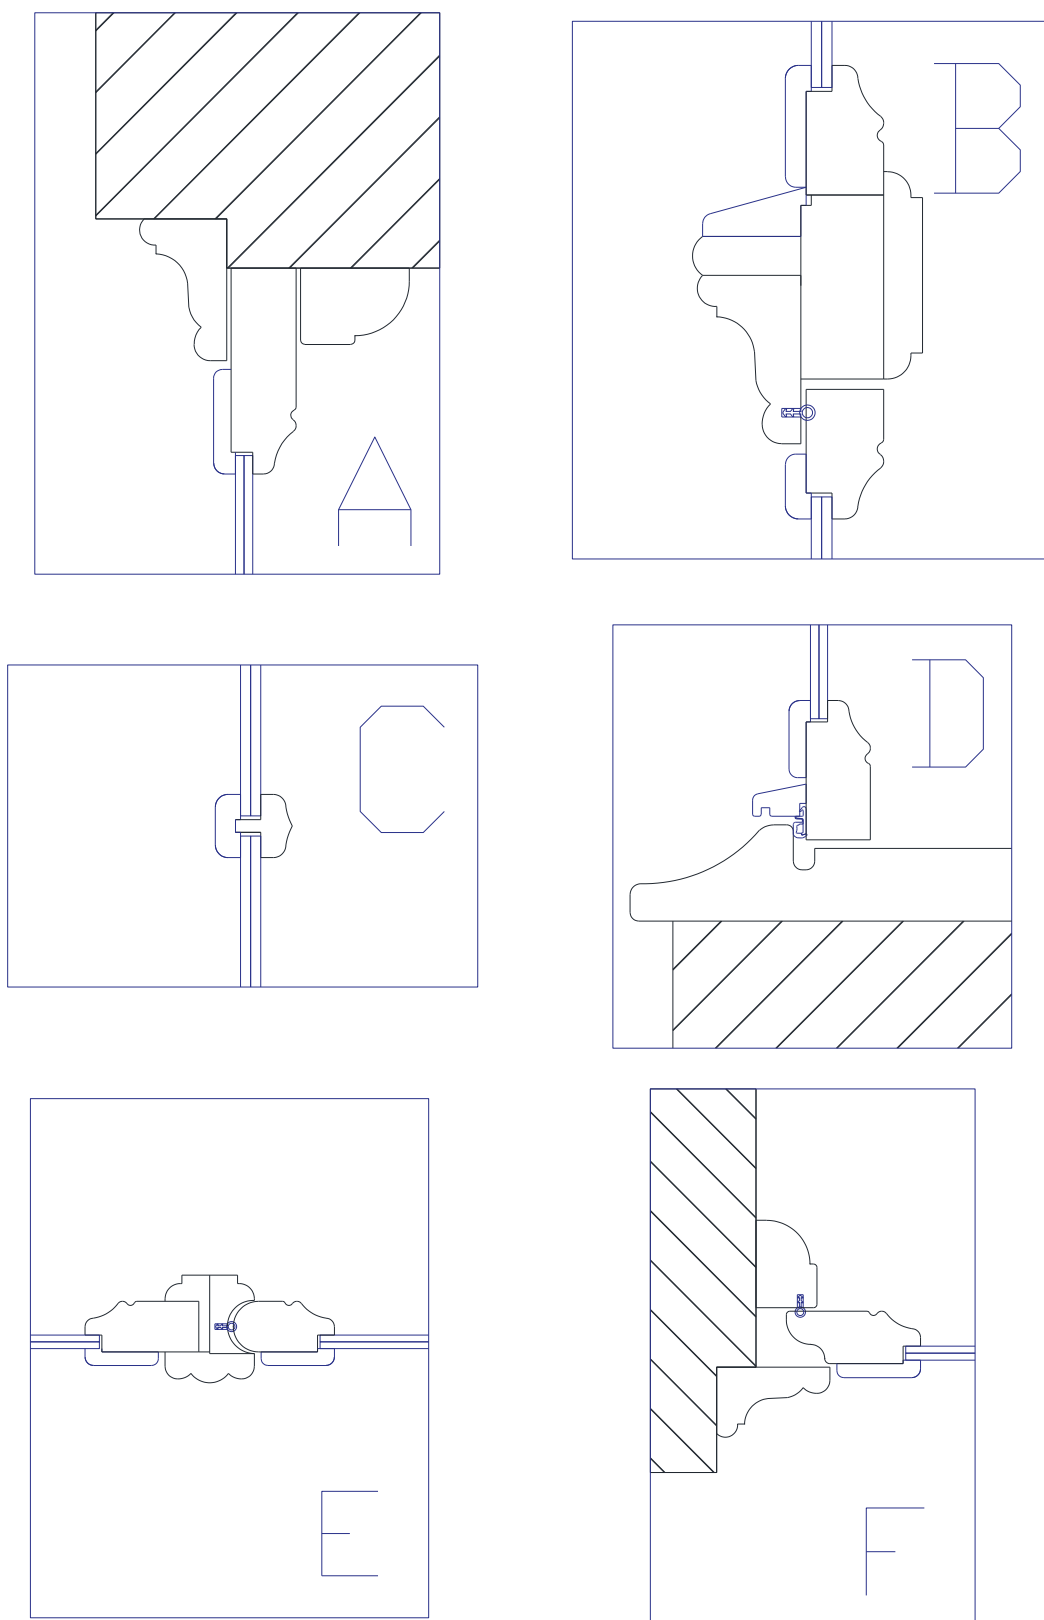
Pormenores de A a F do vão envidraçado reparado.
